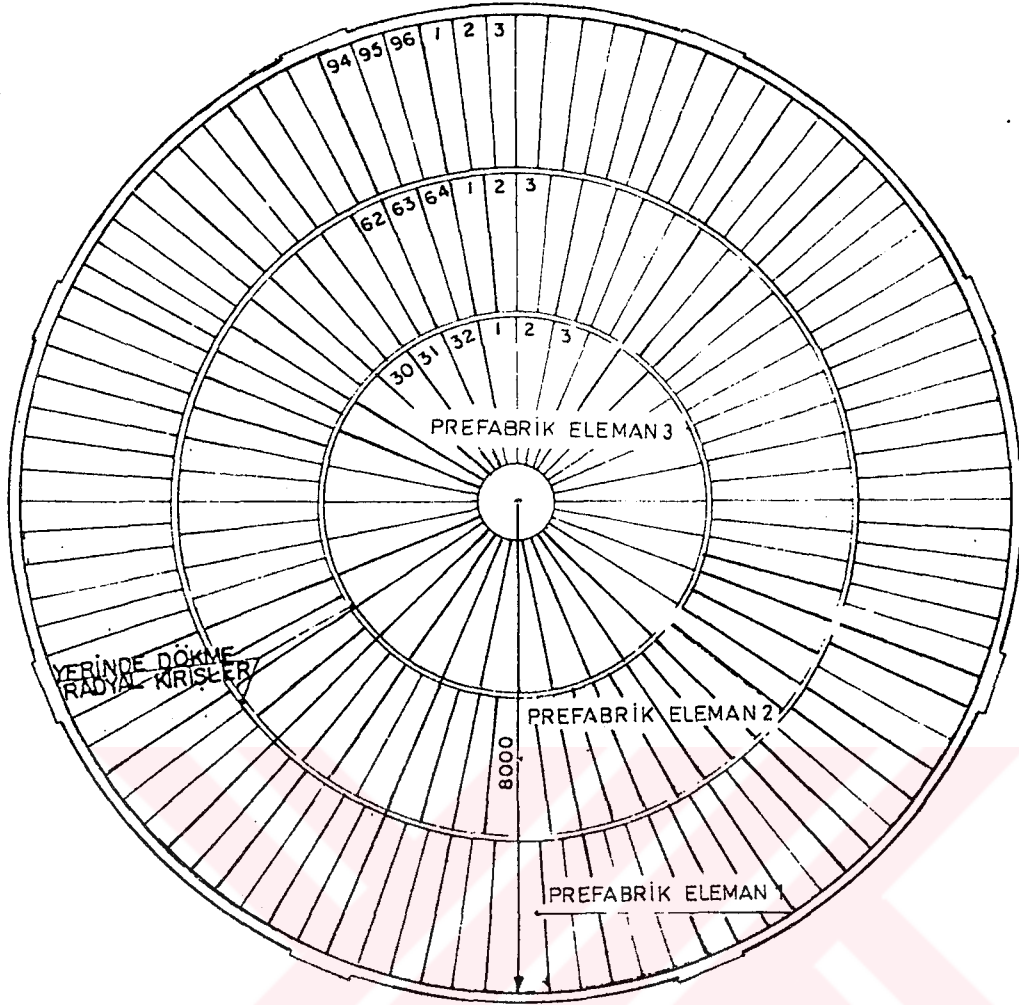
Prefabrik Elemanla Yerinde Dökme Kiriş Bağlantı Detayı.
